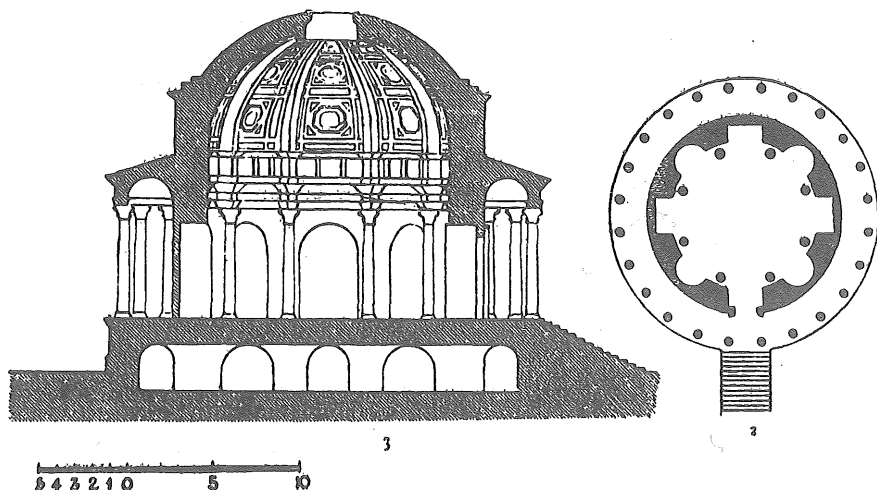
Ostia (Italia). Planta y sección del llamado templo de Portunno. Reconstrucción.
